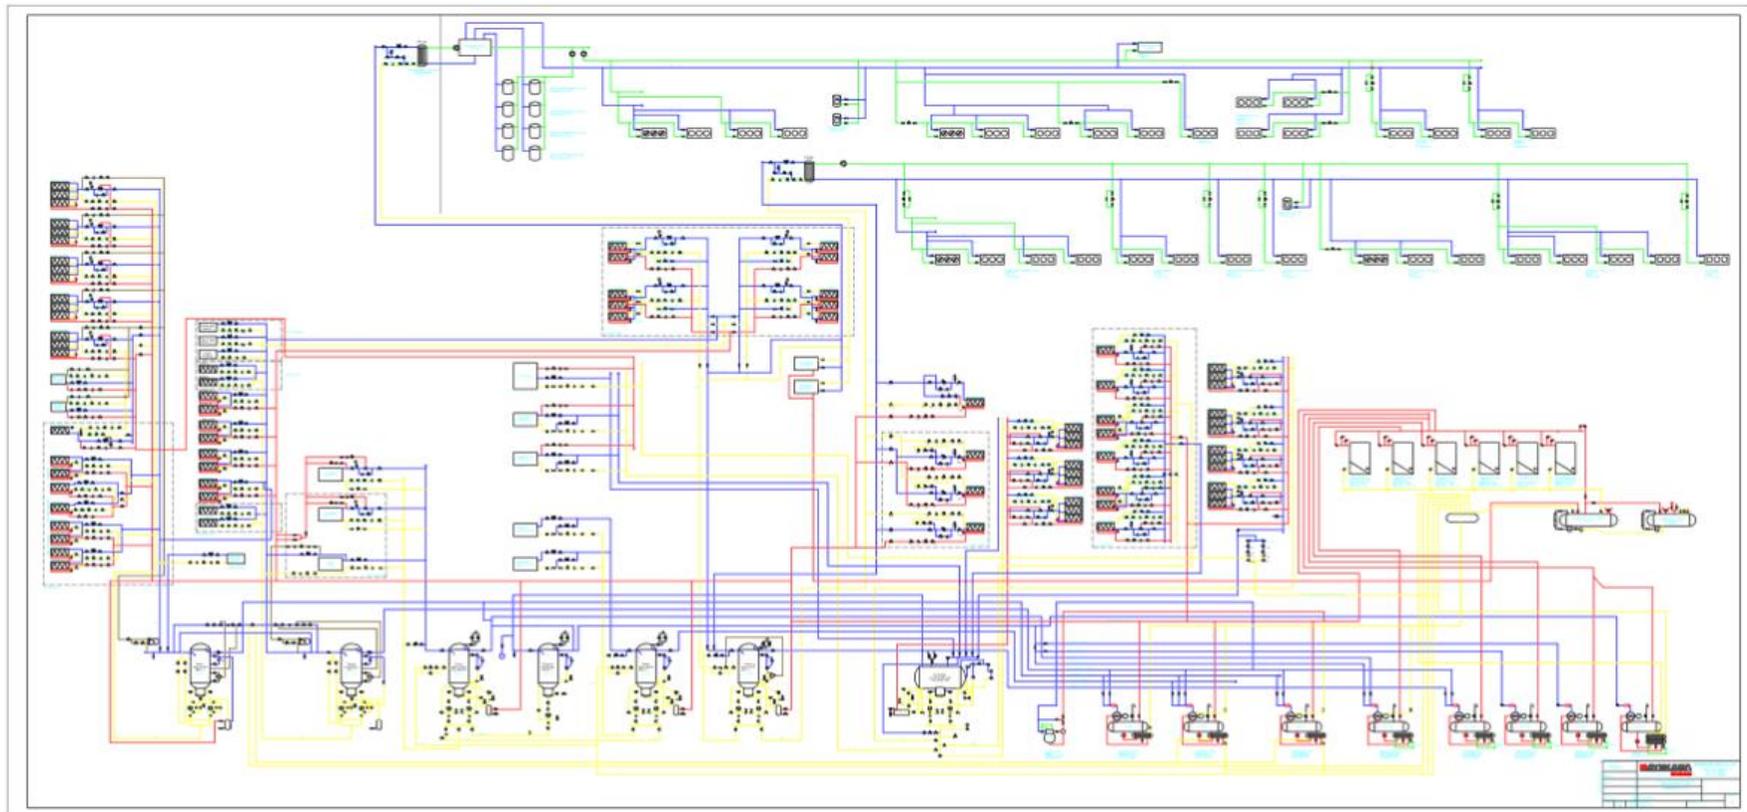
Diagrama de cañerías del sistema completo de refrigeración de la planta.
